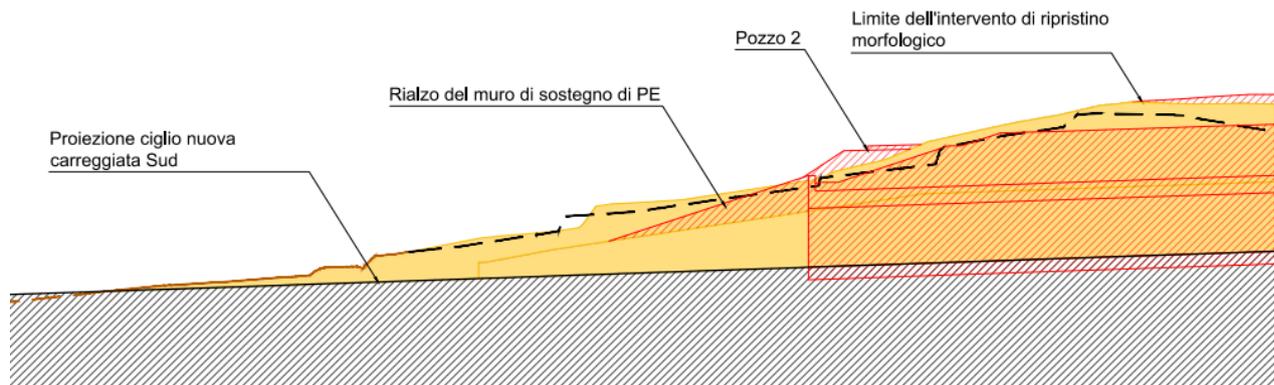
Profilo in asse nuovo imbocco sud galleria artificiale: in tratteggio rosso il tratto con rialzo del muro h 7 m autorizzato (in giallo) nel progetto di ampliamento alla terza corsia
